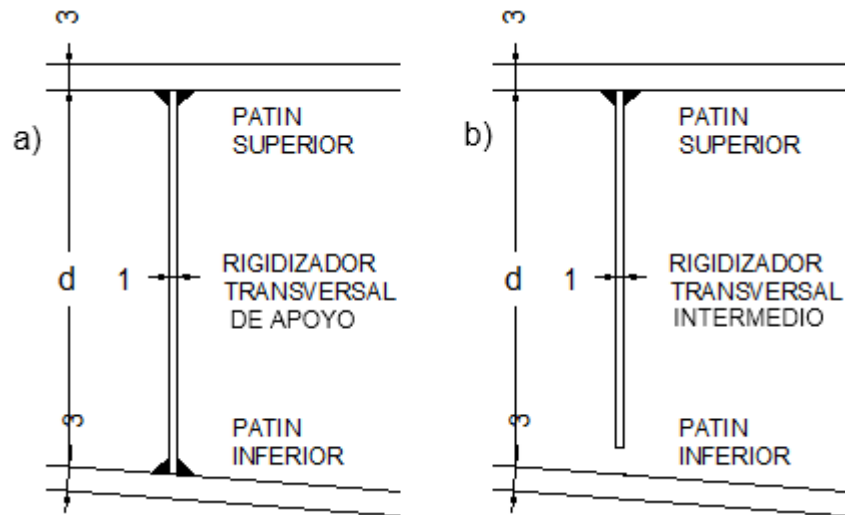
Ubicación del cordón de soldadura patín superior e inferior con el rigidizador transversal de apoyo (a). Ubicación del cordón de soldadura patín superior con el rigidizador transversal intermedio (b) (vista lateral)
